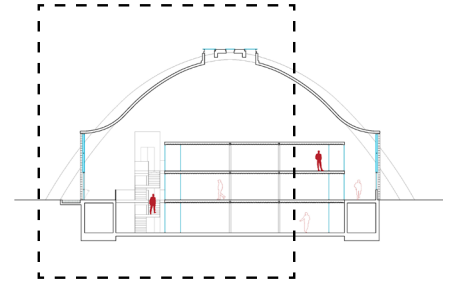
Detalle Sección Tipo. Edificio Nave Embarcadero, Nieto & Sobejano Arquitectos, Cáceres, España, 2008 (Fuente: Elaboración propia)
